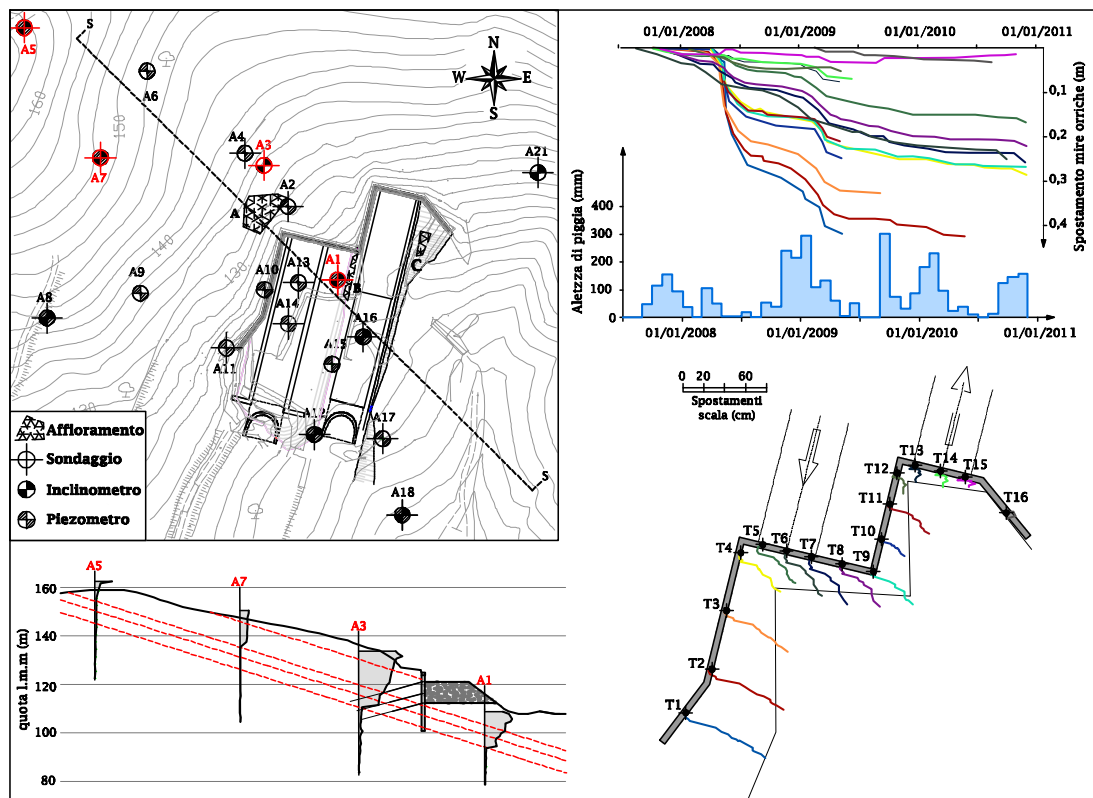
AS, ubicazione strumenti di indagine; AD storico spostamenti e piogge mensili; BS, letture inclinometriche; BD, spostamenti planimetrici delle mire ottiche.
